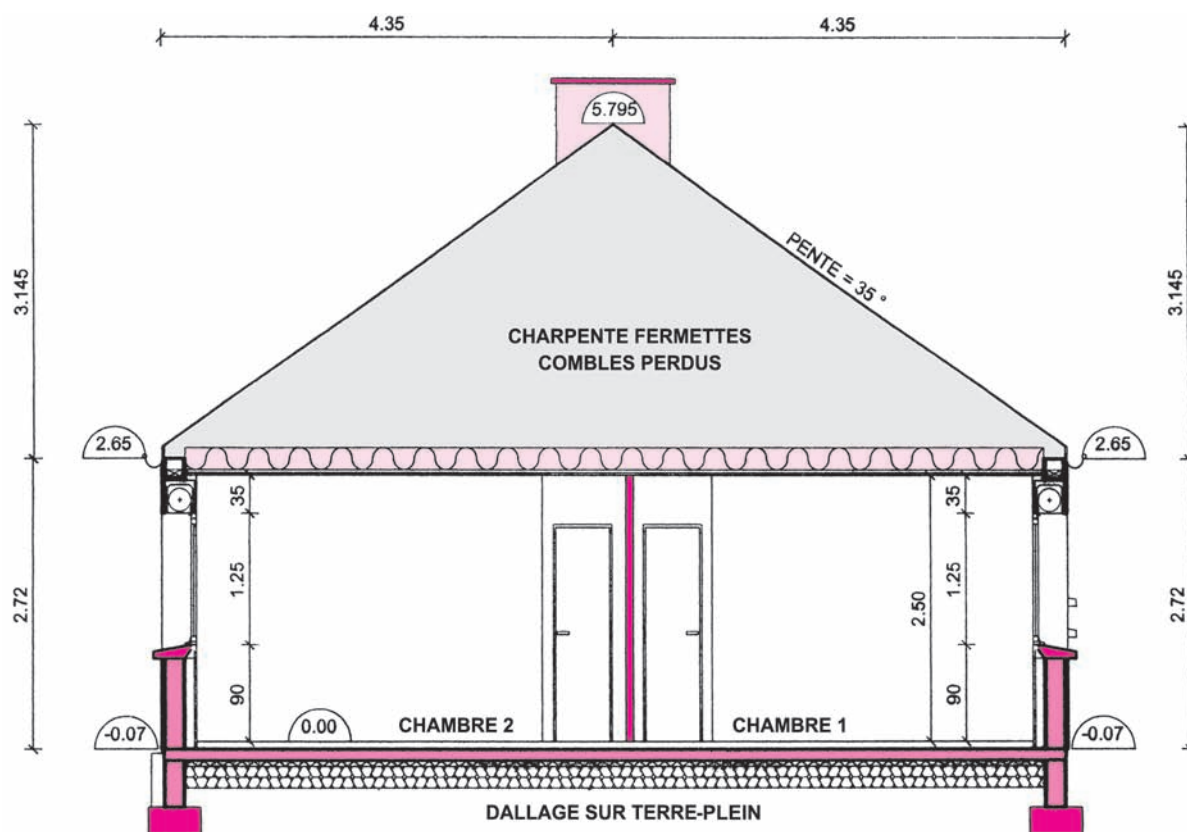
Coupe suivant les repères AA sur la vue en plan → Coupe AA
